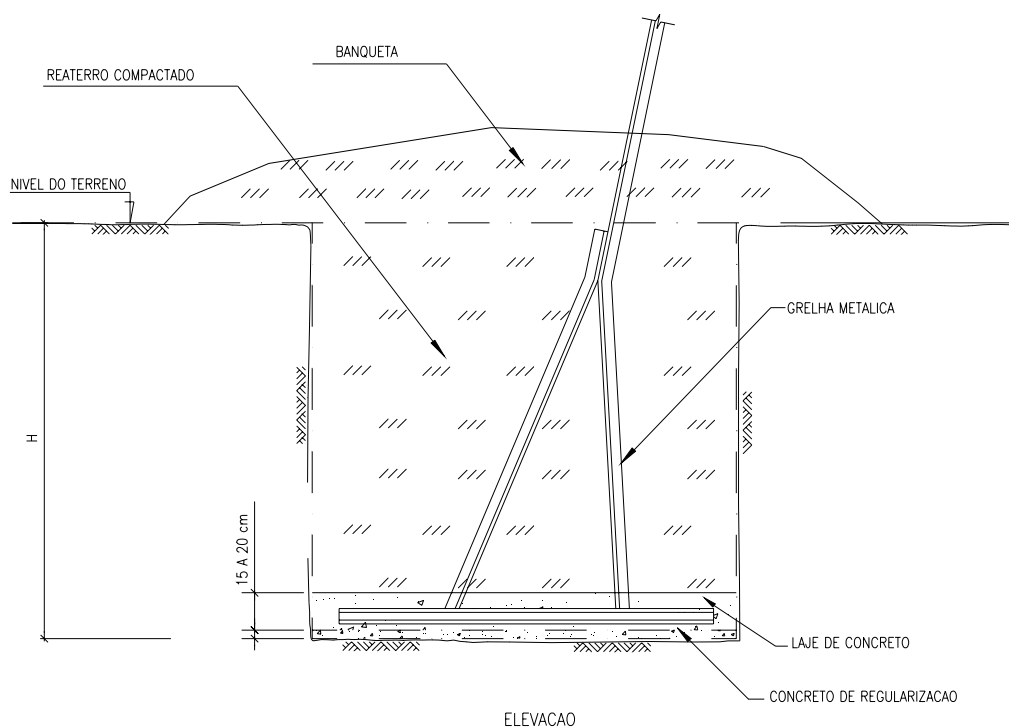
Grelha Metálica com Laje de Concreto (GLC)
